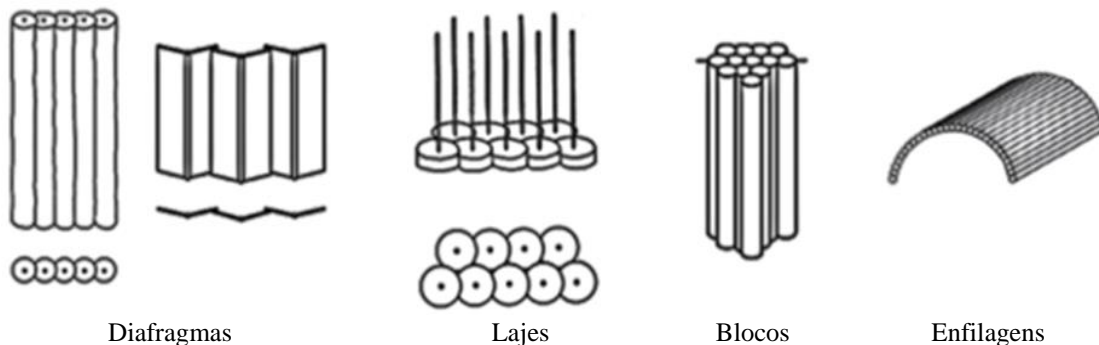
Exemplos de estruturas de *jet grouting* [5, 22]
